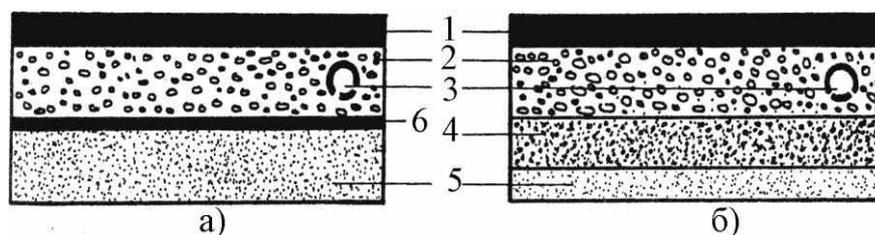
Схема конструкции пластового дренажа с геотекстилем (а) и с песчано-гравийным фильтром (б)
